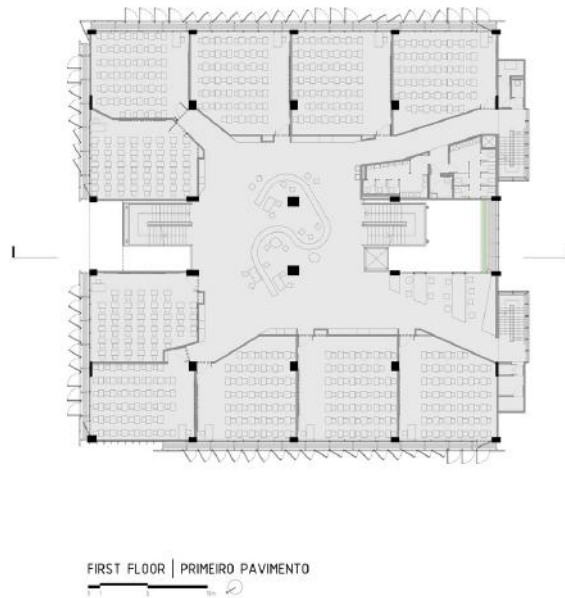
Planta Baixa – Primeiro Pavimento /
